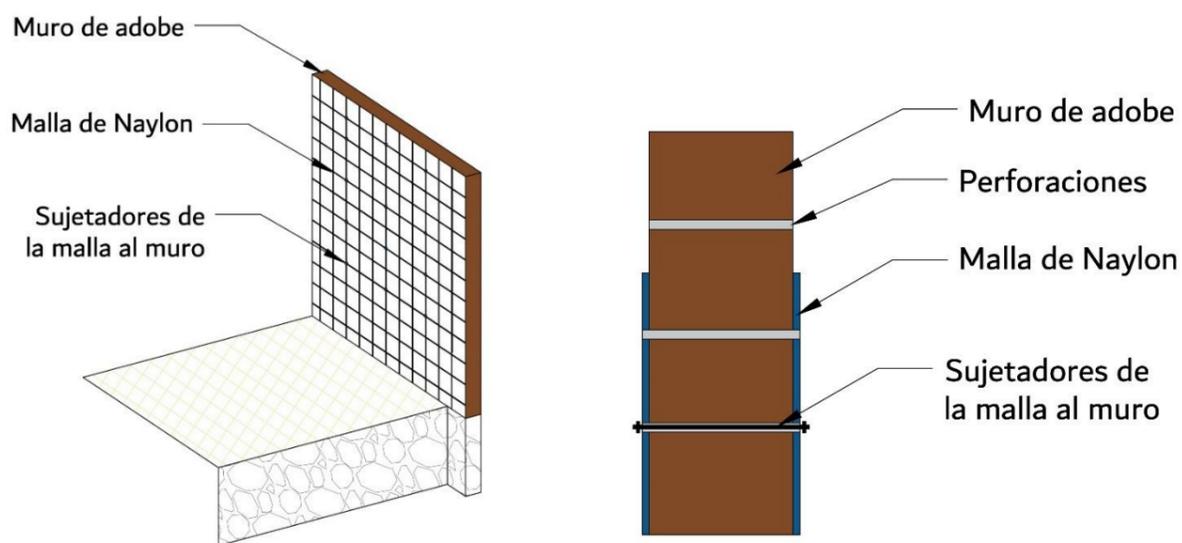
Detalle de malla en muros. Fuente Luis Segovia 2023
